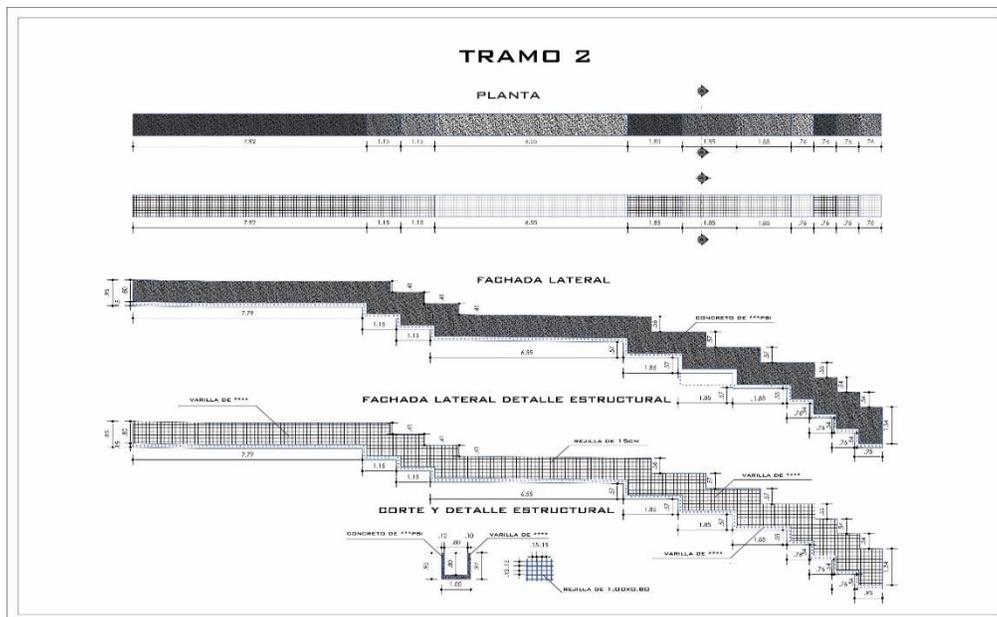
Figura: Plano tramo 2 perfil longitudinal, planta y detalle estructural.
